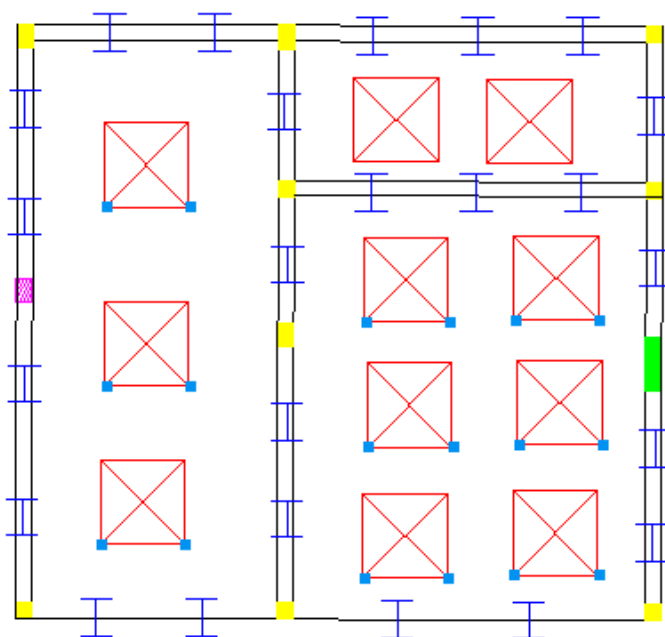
PLAN DE CALEPINAGE D'ETAIEIMENT POUR LA VARIANTE EN PREDALLES
